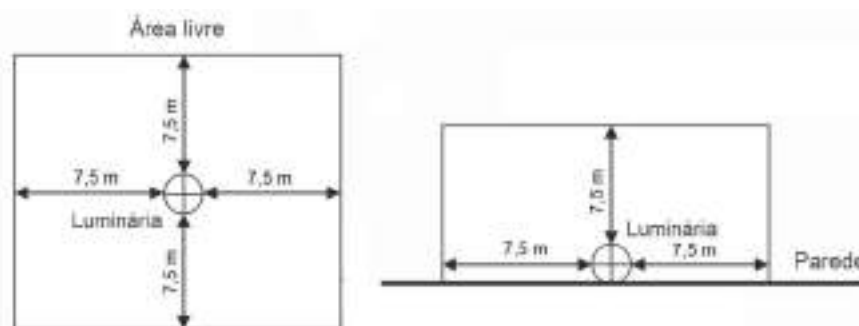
Exemplo de indicação em planta baixa, de instalações de pontos de luz para iluminação de emergência, em tetos ou paredes
